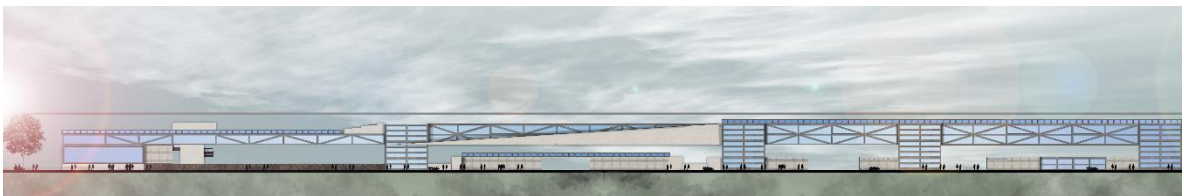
Fachada este. Muestra un alzado ilustrado de la viga viereendeel en fachada con los materiales mencionados anteriormente. Elaboración propia
